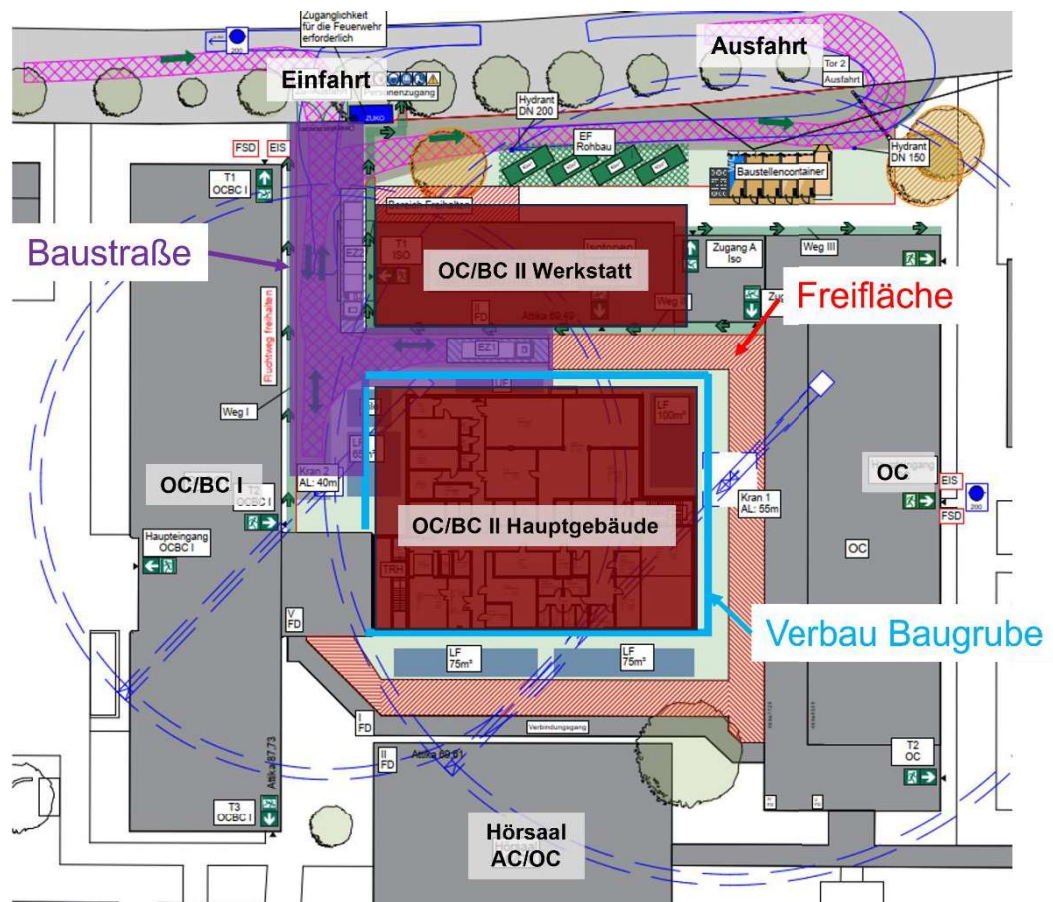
Lageplan aus [1] mit Kennzeichnung der Baustraße, der Logistikflächen und dem groben Verlauf des Baugrubenverbau, grau: Bestandsgebäude, dunkelrot: Neubau.
